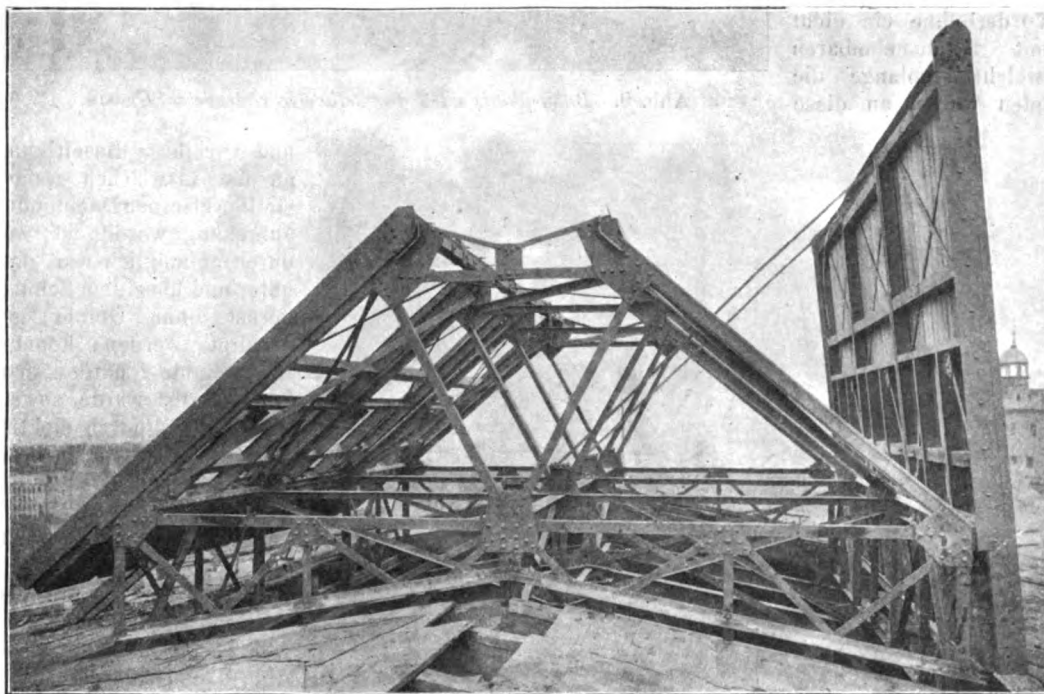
Dachaufbau mit geöffneten Rauchklappen.
